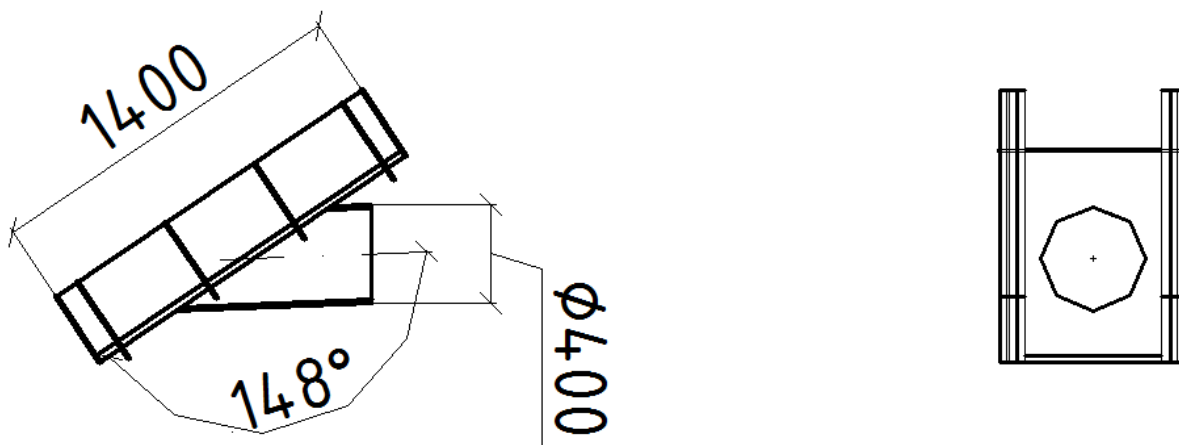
ВД-003.1-1 Быстроток соединительный 400х600 с патрубком.
